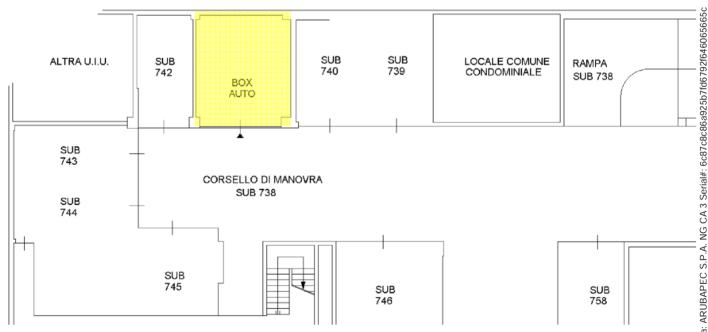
Fotografia del e ingresso al corsello dei box di Via Roberto Lepetit n.12, Milano (MI) - planimetria dell'autorimessa (evidenziata in giallo).
